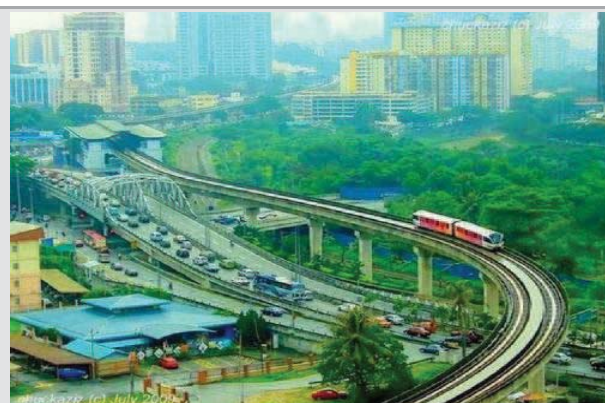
Sistema de VLT elevado de Kuala Lumpur (detalhe da passarela de segurança)
